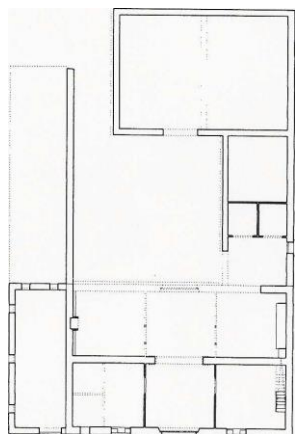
Planta de una alquería con dos crujiás paralelas a la fachada, otra articulada y el corral tras la fachada posterior².
